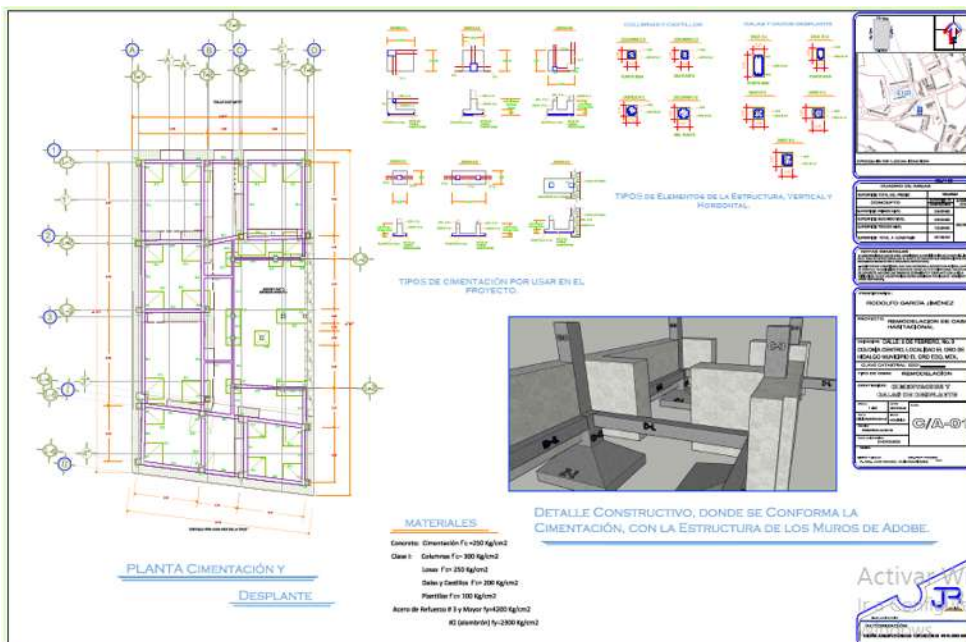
Imagen del Plano resultante de la propuesta del tipo de Cimentación, así también el tipo de dala de desplante, como dados y columnas. Se presenta una detalle constructivo de la forma como se integra la cimentación de forma conjunta con los muros de adobe para su reforzamiento, además una especificación del tipo de material a utilizar.
